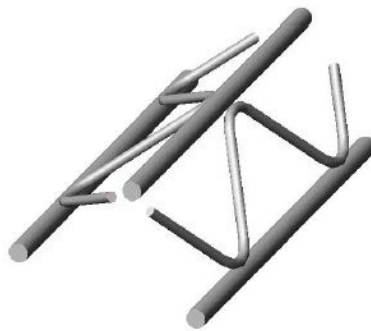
Armadura pré-fabricada da vigota treliçada
